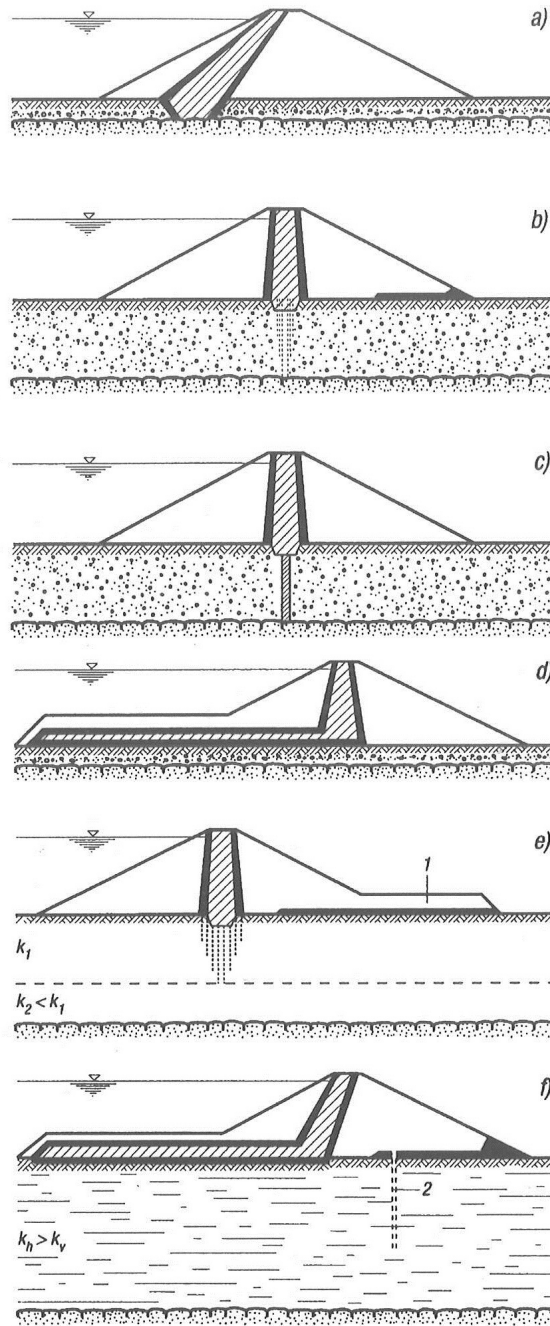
Dammgründungen - a) direkter Anschluss an dichten Untergrund, b) Dichtungsschleier (ein- od. mehrreihiger Injektionsschirm), c) Schlitzwand, d) Dichtungsteppich, e) Dichtungsschleier mit Druckbank, f) Dichtungsteppich mit luftseitigen Entwässerungsanlagen, 1 Druckbank, 2 Dichtungswand [4]
